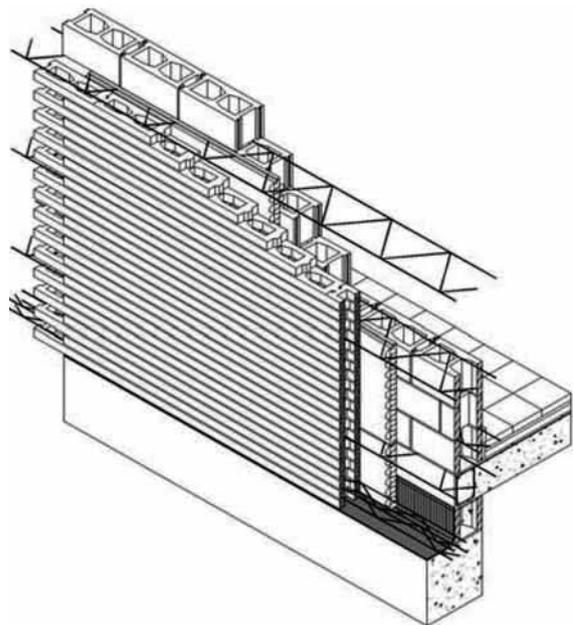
Perspectiva de arranque sobre cimentación de muro de 2 hojas de ladrillo alargado y bloque hueco de carga. Hojas solidarizadas con cerchas de tendel a caballo de ambas (DCW) dejando cámara de aire intermedia con aislamiento.
